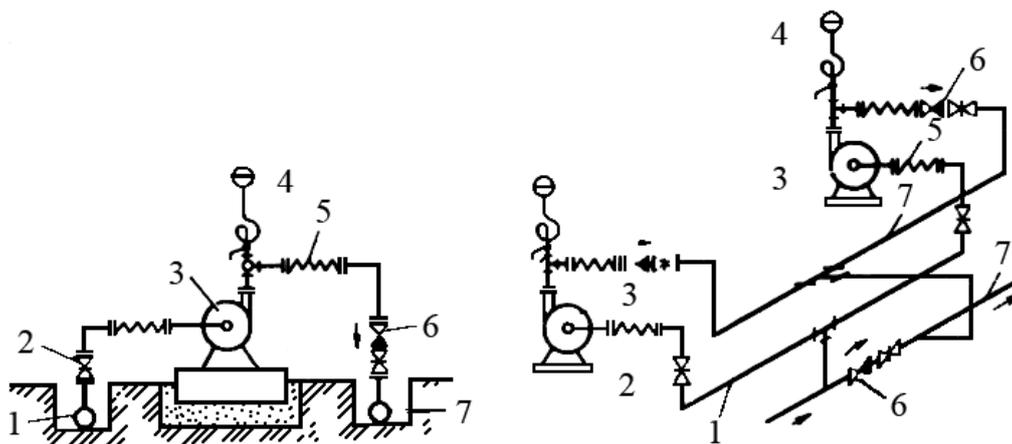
Схема обвязки насосов: 1 и 7 – всасывающий и напорный трубопроводы; 2 – запорная арматура; 3 – насос; 4 – манометр; 5 – вибровставка; 6 – обратный клапан
